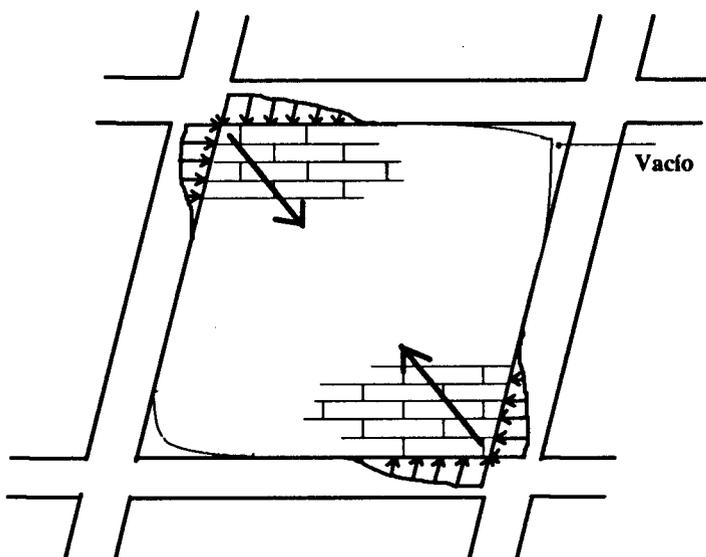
Pórtico de hormigón confinado por muros de mampostería, idealización del muro
